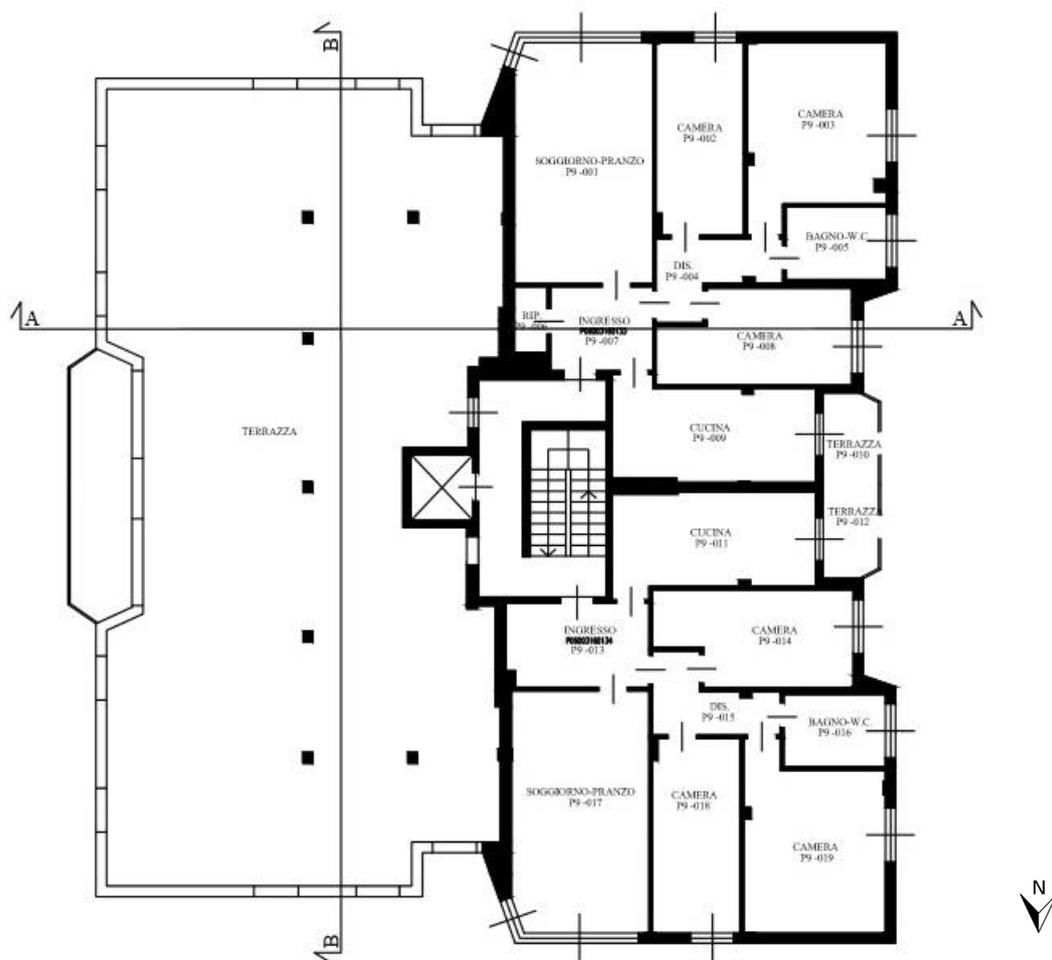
Pianta piano nono, via Brofferio 1. Scala 1:200. Fonte: Ater Padova.
